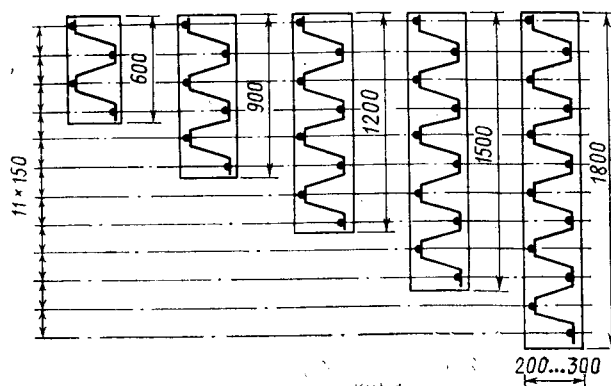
Схема армирования панелей сетками с поперечной волнообразной арматурой
